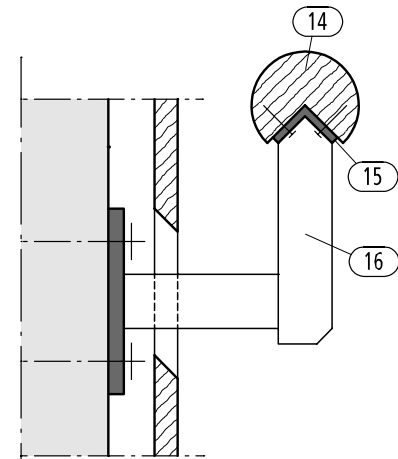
Anschluss Handlauf bei einer hohen Trogbrücke
